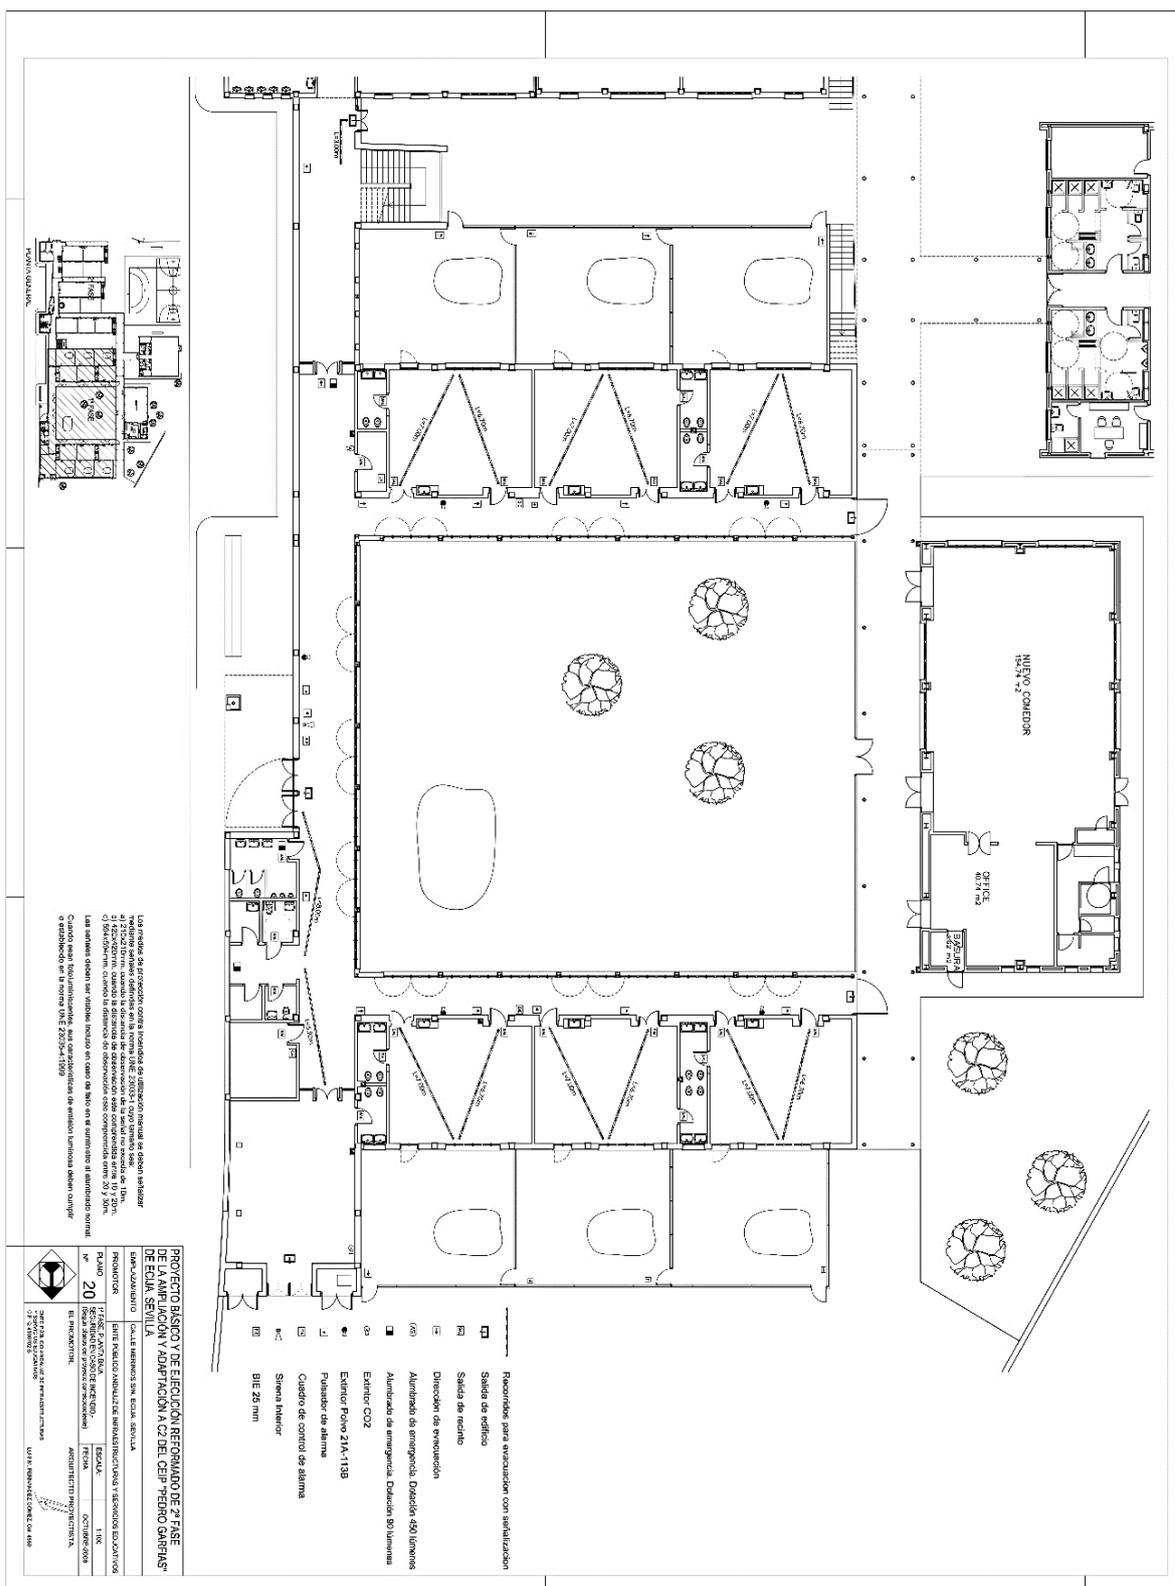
Plano Emergencia. EDIFICIO DE INFANTIL -PLANTA BAJA-
